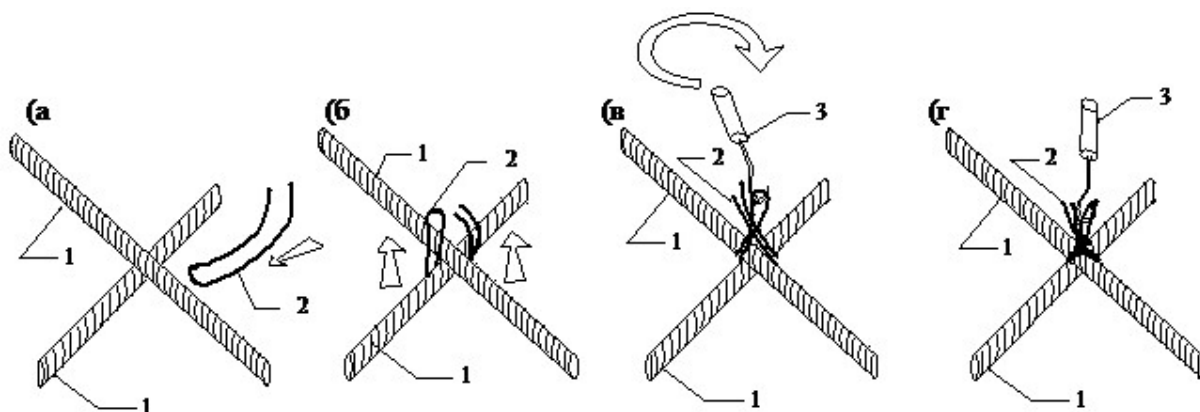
Схема фиксации арматурных стержней вязальной проволокой: а) продерживание проволоки под узлом; б) выравнивание концов проволоки; в) скручивание концов проволоки вязальным крюком; г) зафиксированный узел: 1 – арматурный стержень; 2 – вязальная проволока; 3 – вязальный крюк.
